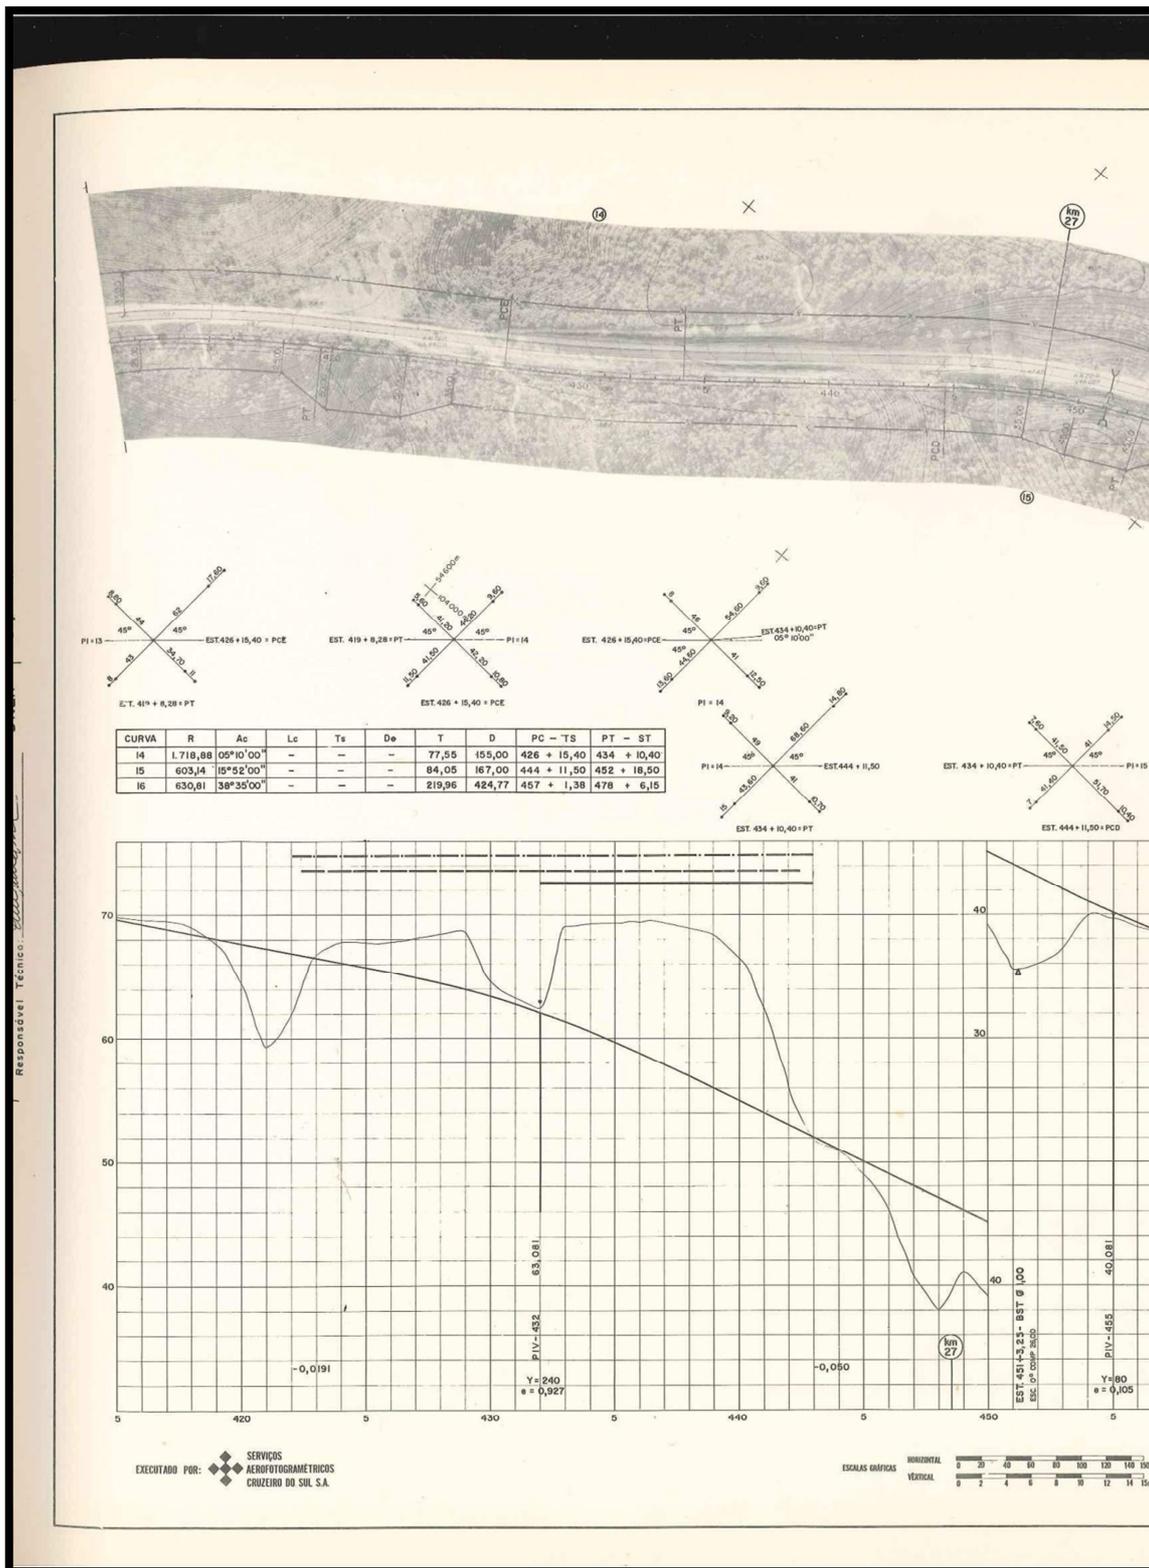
Planta e perfil originais do km-55. . (Fonte: DNER.)
